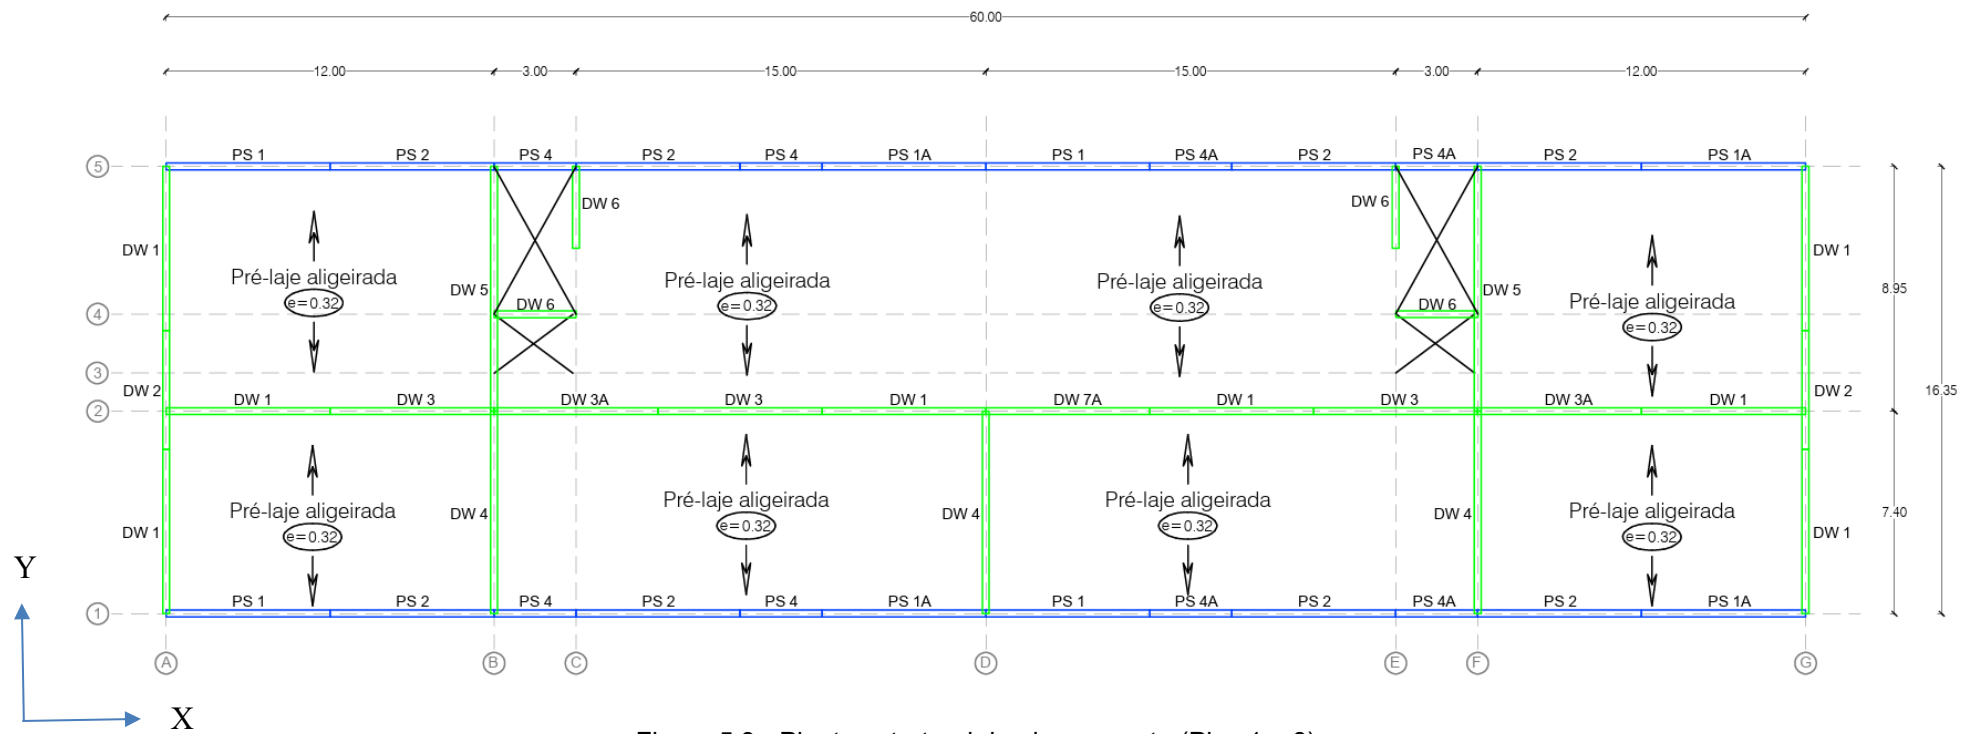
Planta estrutural do piso corrente (Piso 1 – 8)
